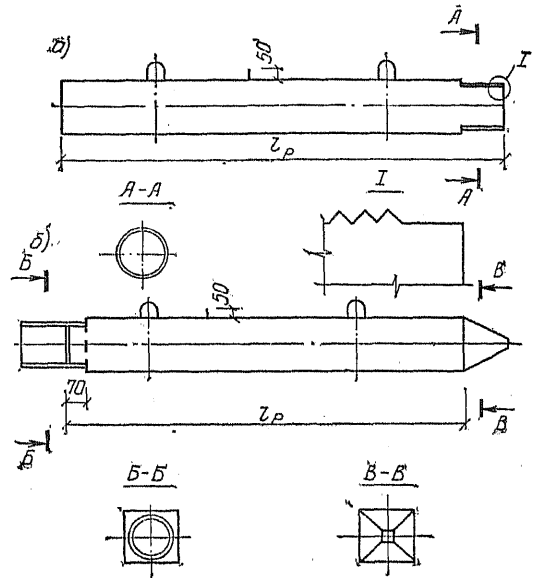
Звенья составной свай со стаканным стыком а — верхнее звено; б — нижнее звено
